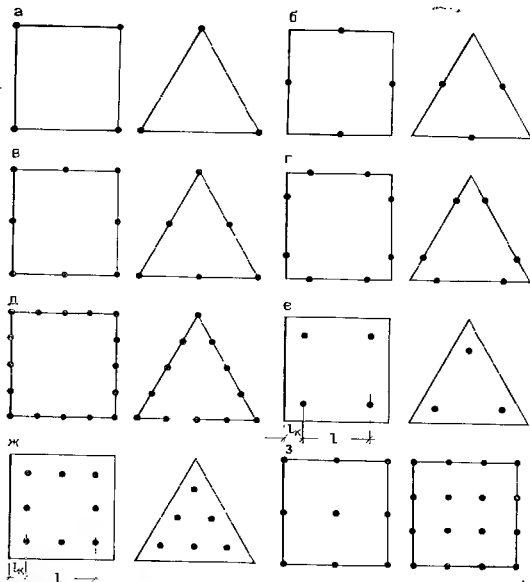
Варианты симметричного размещения колонн для покрытий из стержневых плит с квадратным и треугольным очертанием в плане
